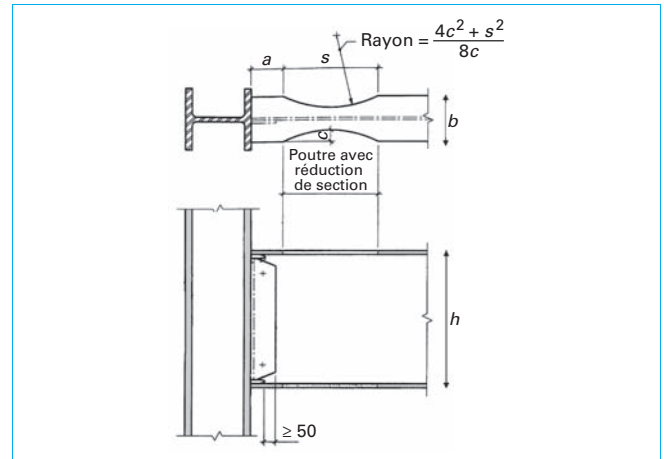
Poutre avec réduction de section. Ailes soudées, âme soudée à un gousset soudé à l'âme du poteau (cf. [Doc. C 2 559])
